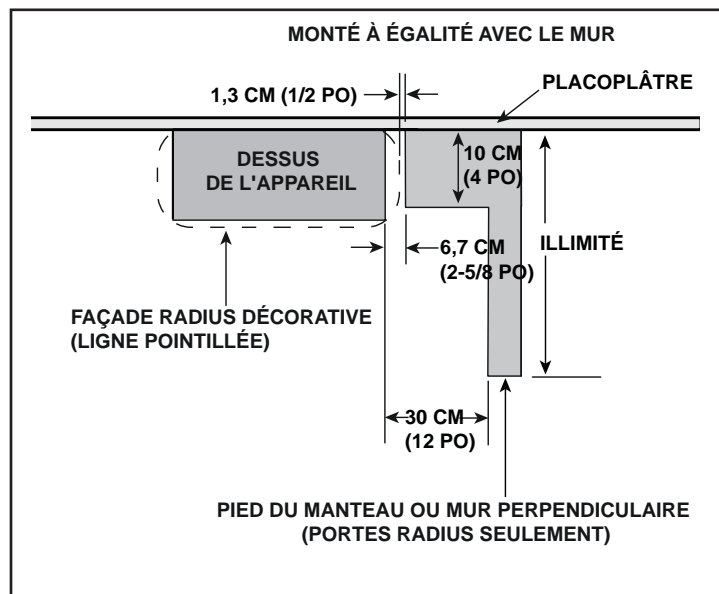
Dégagements du pied du manteau du foyer ou saillie du mur (acceptable de part et d'autre de l'enveloppe extérieure)
